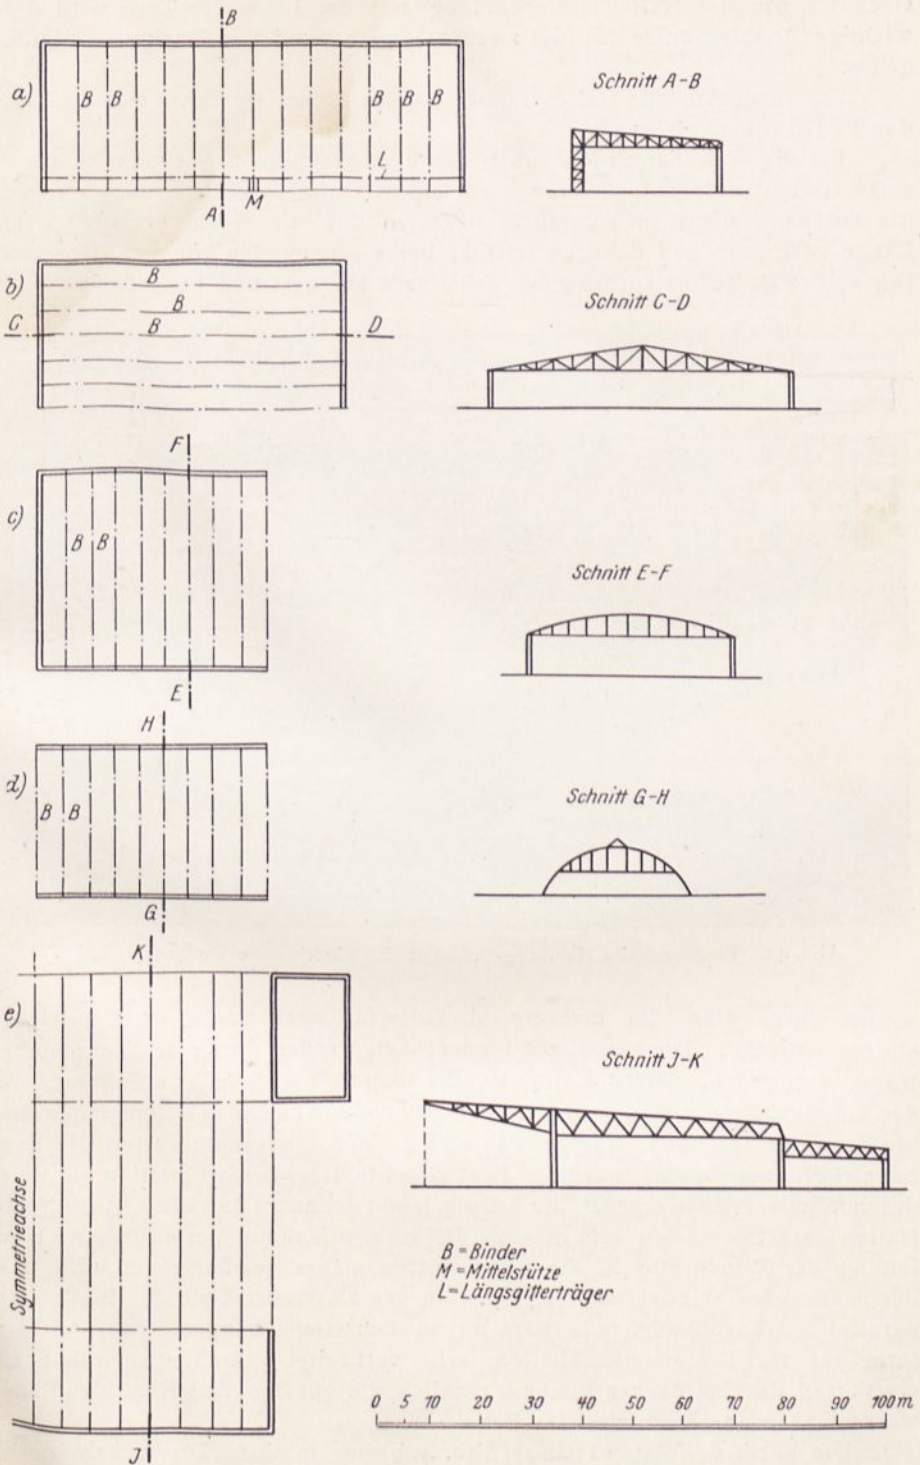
Dachkonstruktionen für Flugzeughallen.
